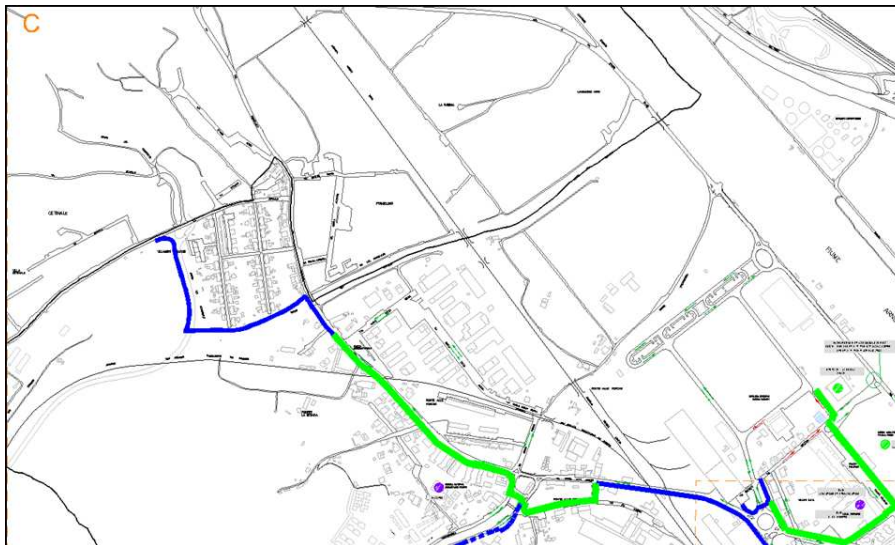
La rete ciclo-pedonale di progetto nella zona di Ponte alle Forche
